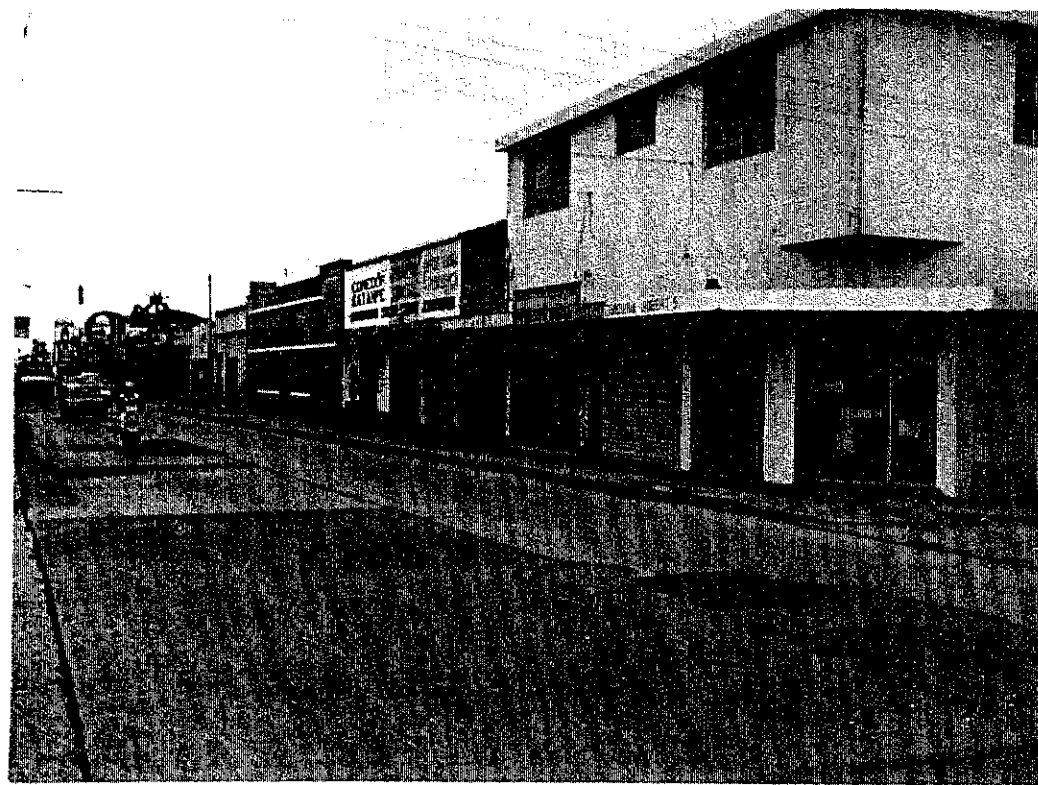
Vista sobre la 10a Avenida entre 14 y 14 Calle "A" se observa la falta de unidad de la horizontalidad de las fachadas
